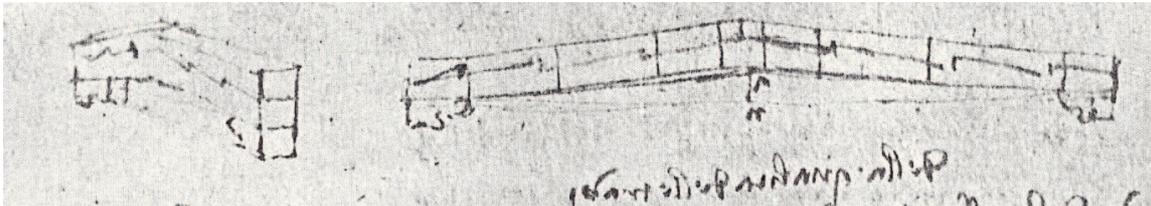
Poutre armée (détail). Léonard de Vinci, *Legnio armato*,
